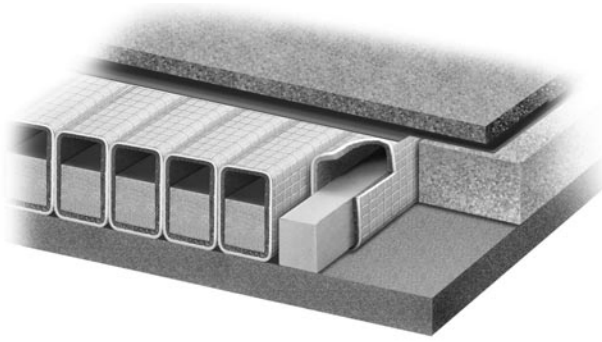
Die Missel Kompakt-Dämmhülse ist rechteckig, schmal, niedrig, reißfest und gepolstert. Sie erfüllt damit alle Voraussetzungen für einen fachgerechten Fußbodenaufbau.
